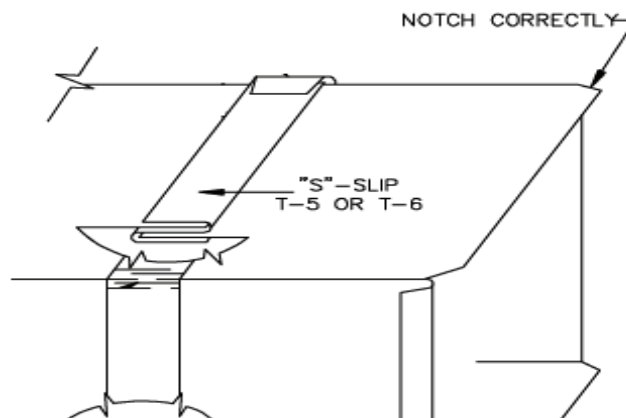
Juntas Transversales tipo S-Slip y Drive Slip, para ductos de extracción de aire ⁶⁹
